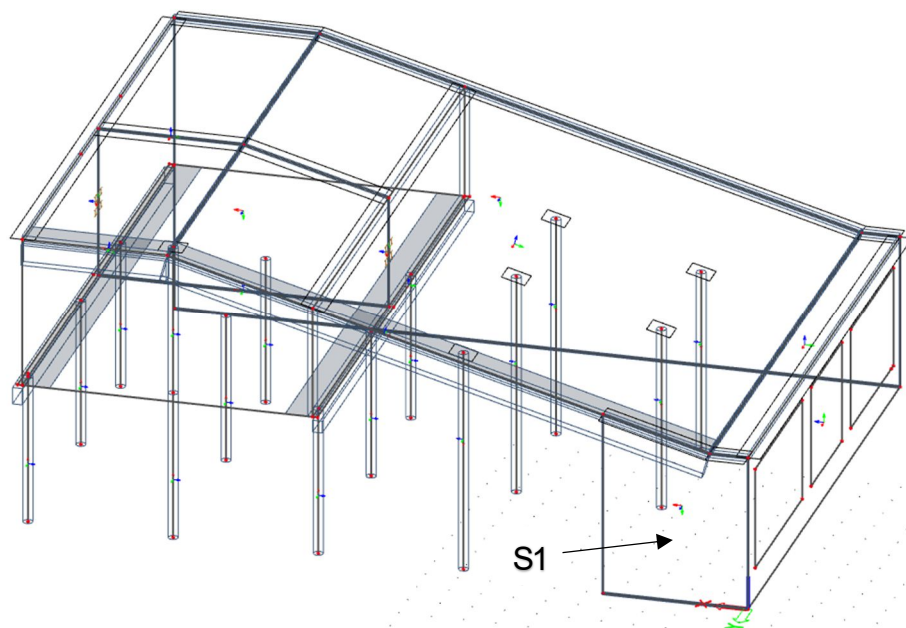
Prostorový model konstrukce – varianta 0
